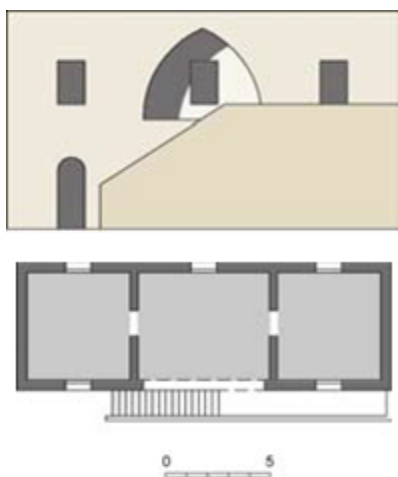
Em cima: Planta e alçado da casa com Liwan
